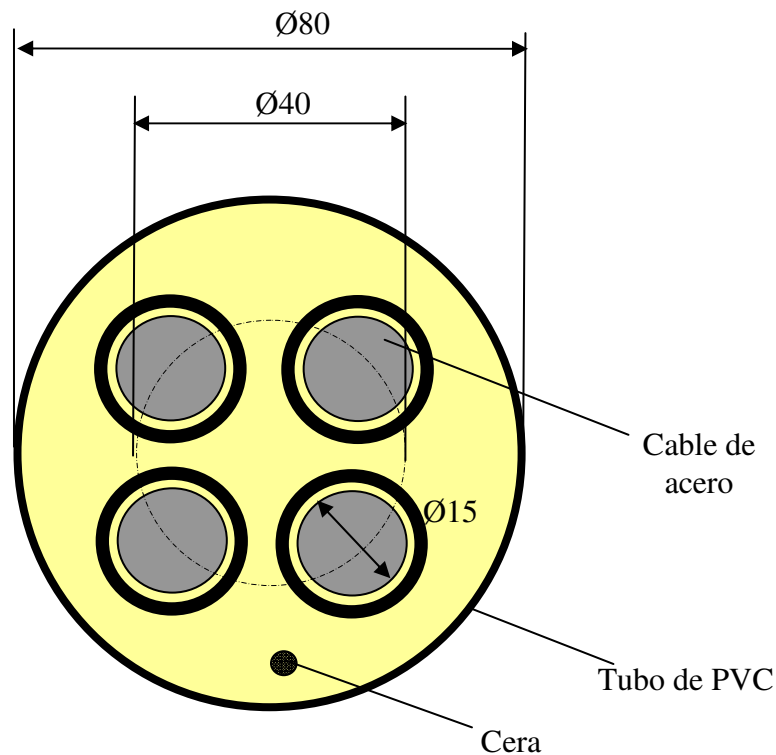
Detalle de la sección del cable estructural. (Dimensiones en mm)
